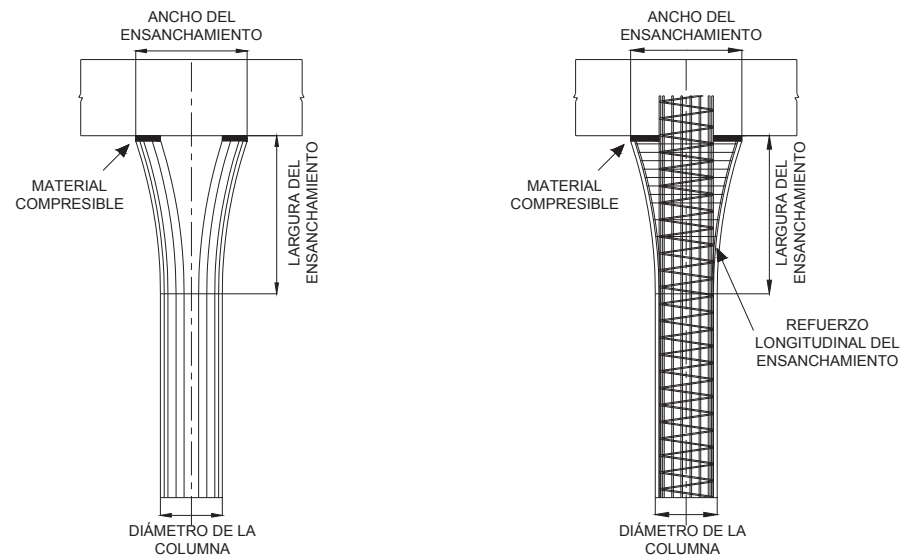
Detalle del reforzamiento en una columna aislada, con ensanchamiento. (Fuente: Nada et al., 2003)
